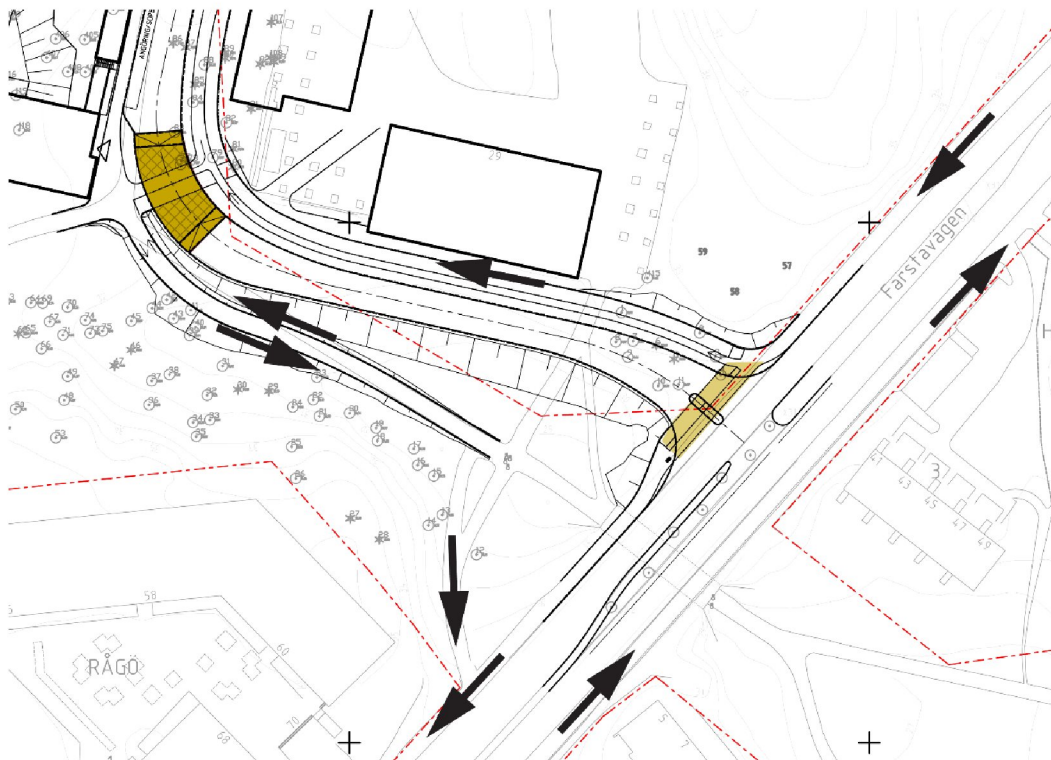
Möjliga cykelstråk mellan Farsta Centrum och Kvickenstorpsskolan illustreras med gultstreckade linjer.
